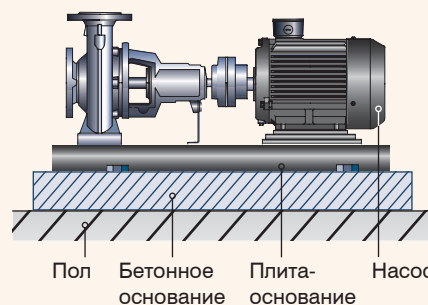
Монтаж на «плавающем» фундаменте
